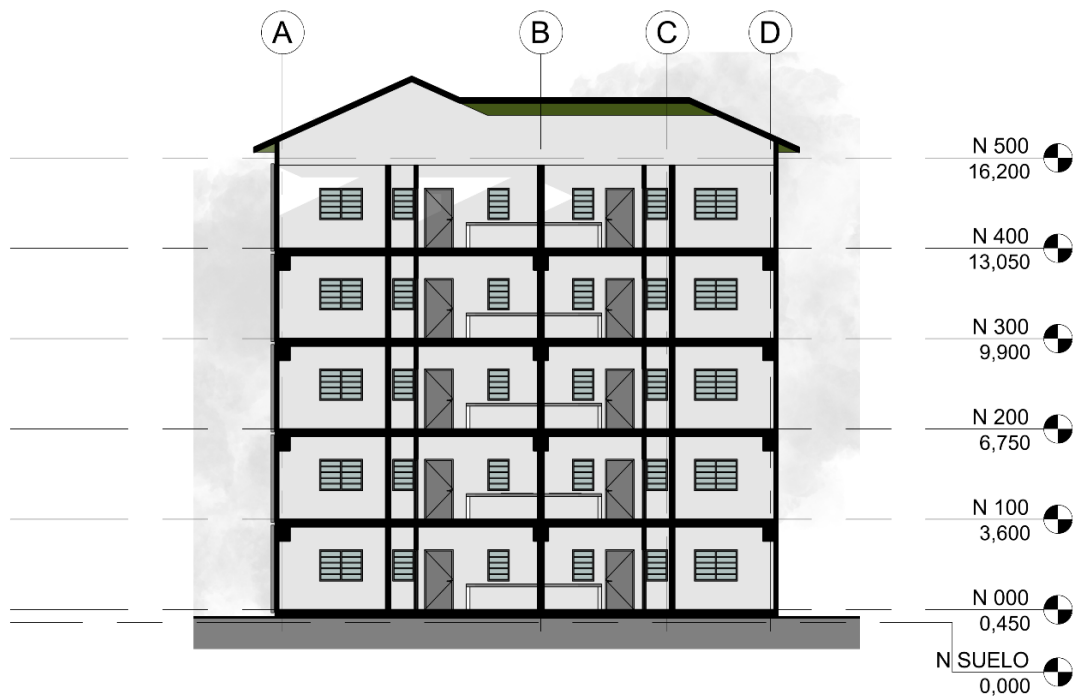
SECCIÓN TRANSVERSAL EDIFICIO 4 | Elaborado por: El autor
